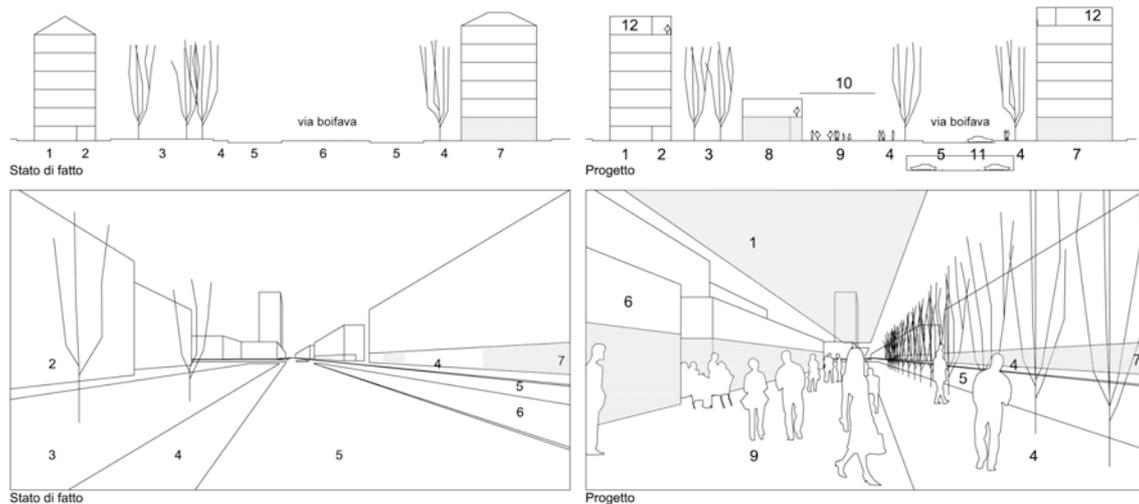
| Quartiere Chiesa Rossa a Milano. Confronto tra la sezione stradale stato di fatto e quella di progetto.
